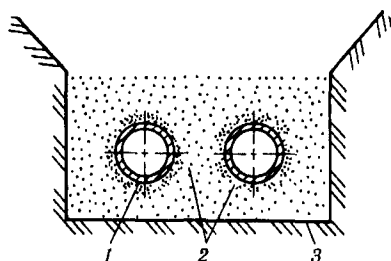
Разрез бесканального теплопровода в самоспекающемся асфальтоне
